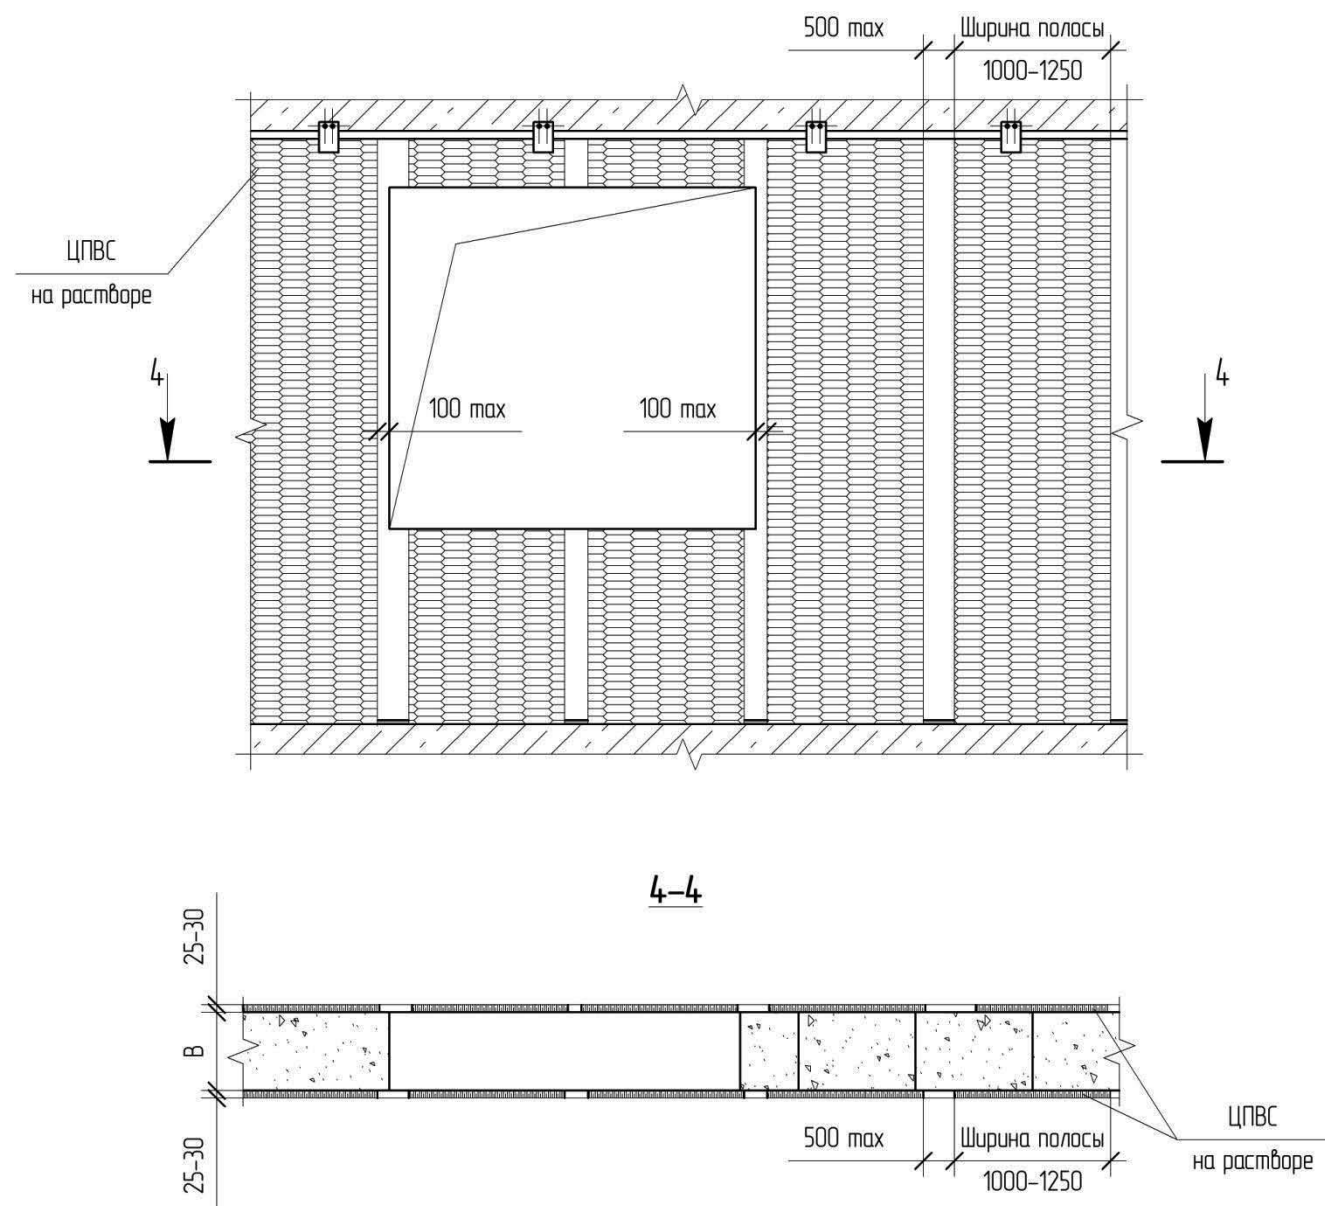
Схема вертикального армирования стен цельнометаллическими просечно-вытяжными сетками
